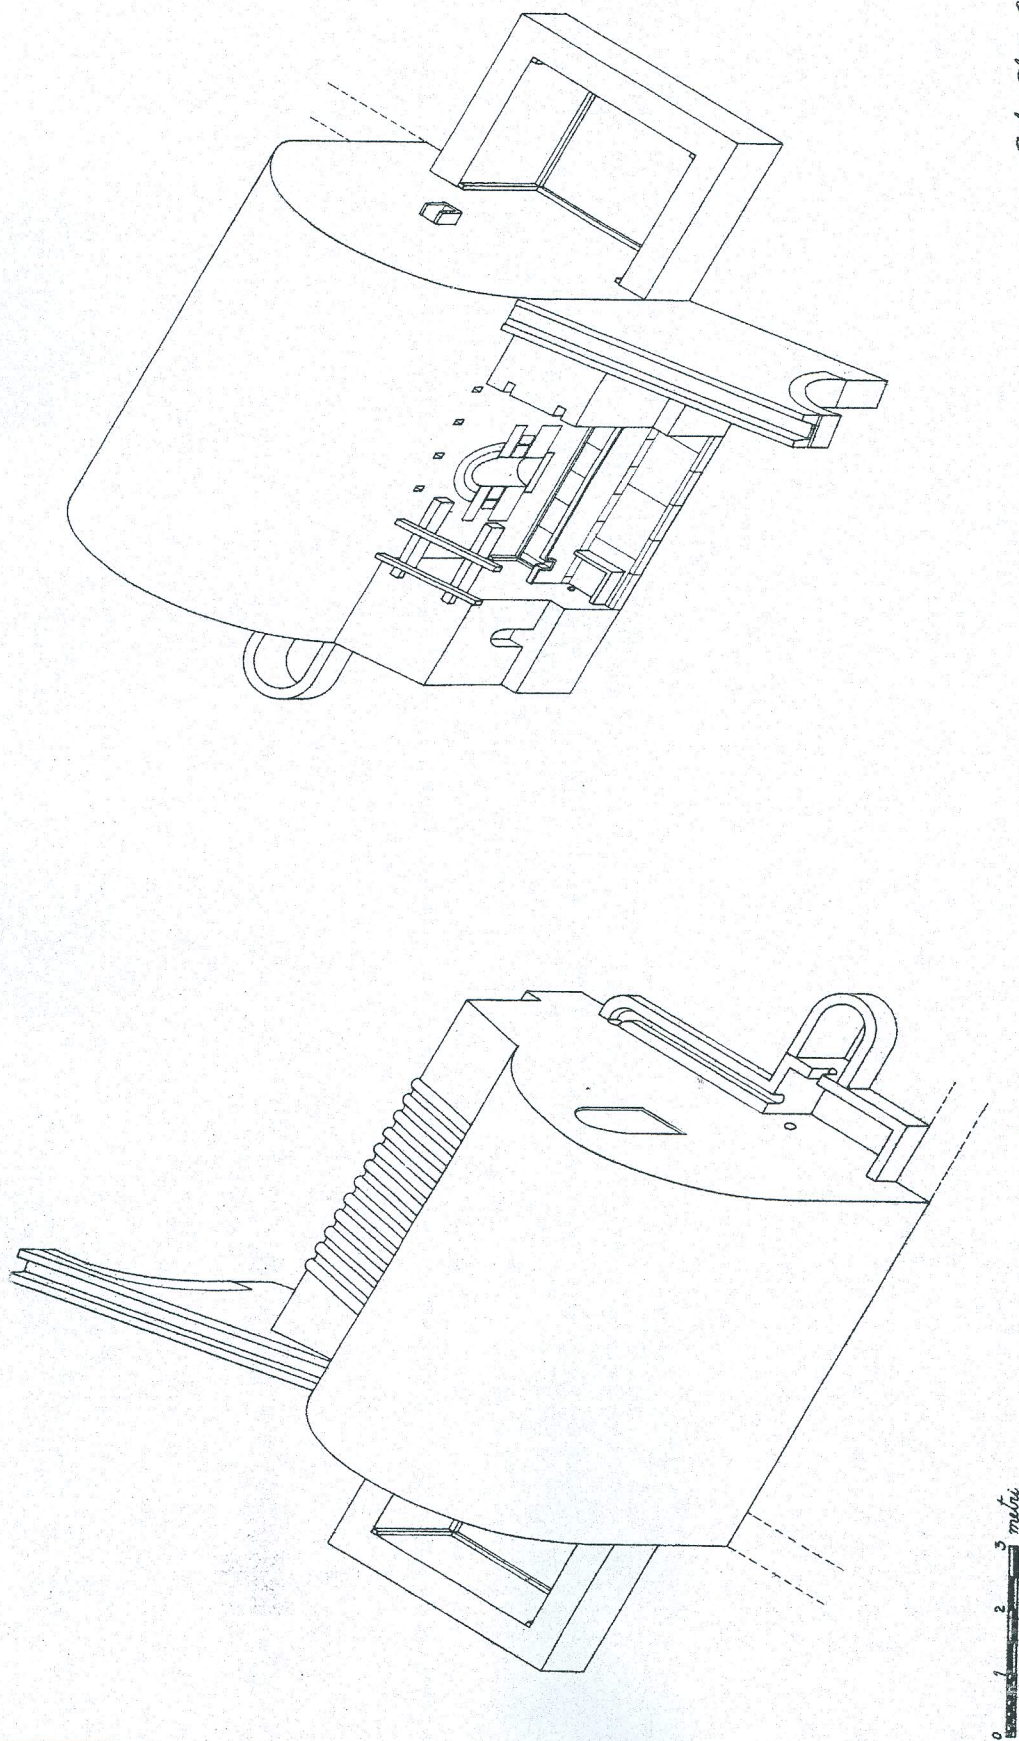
PROSPETTO (CON PIANTA) DELLA FONTANA BIZANTINA N. 4 (*ril. arch. A. Ortega*).
